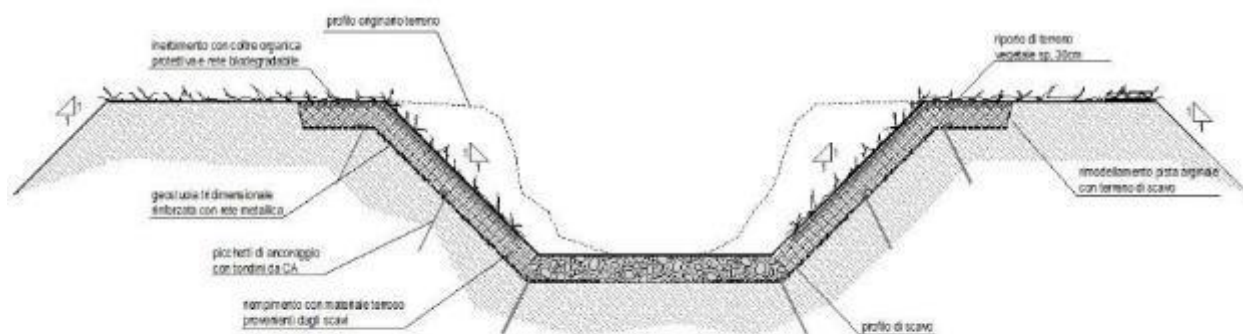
INTERVENTO DI PROGETTO, SEZIONE TIPOLOGICA 2 “CANALE INERBITO”
